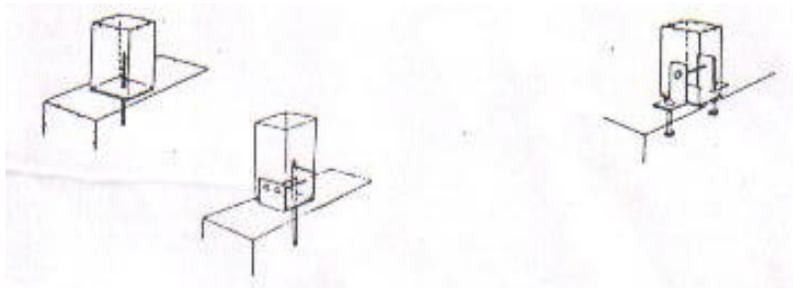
Tipos de uniones de columna a hormigón.
